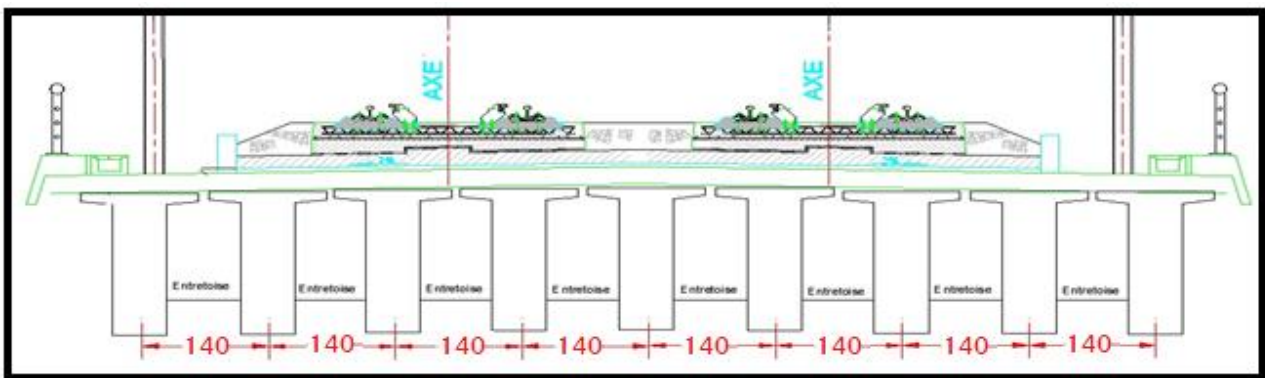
Coupe transversale au niveau d'appui (pont a poutre).
